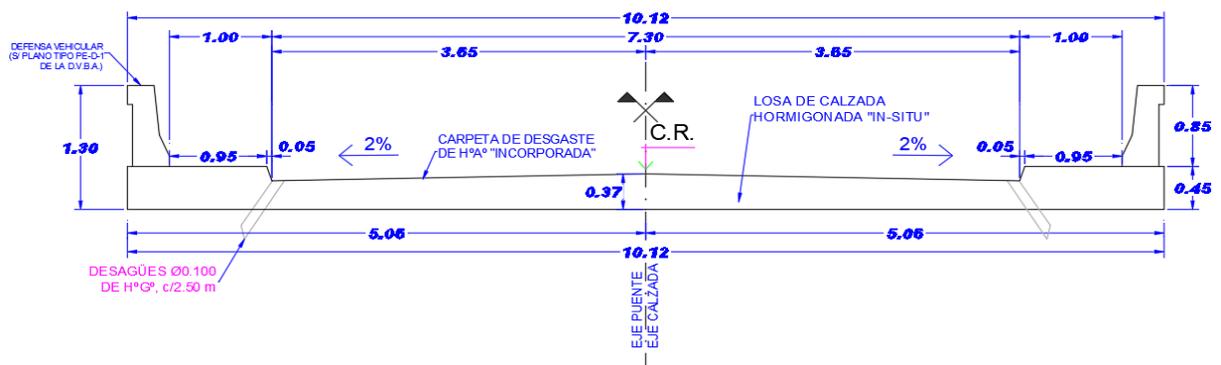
Sección transversal del puente a construir. Fuente: Departamento Estructuras-DPH
